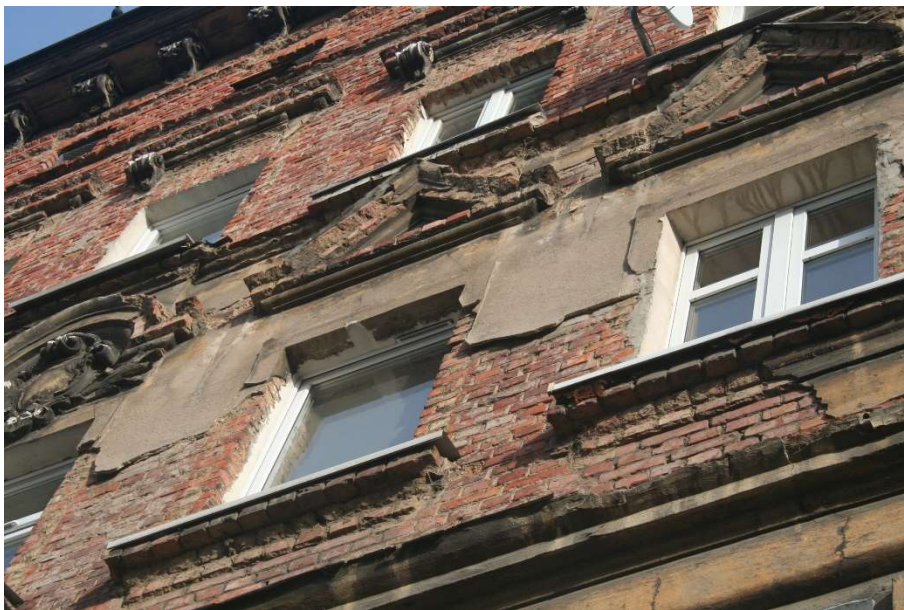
Elewacja od podwórza. Znaczne ubytki zaprawy w spoinach
